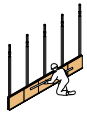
Aplicación de material sellante en forjado superior con viguetas paralelas a separadora.
